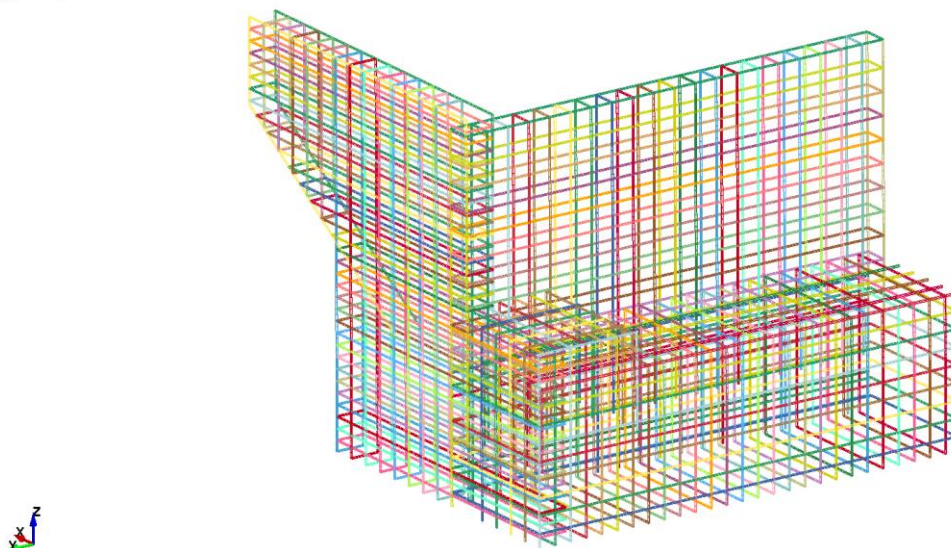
Vista de Acero en Modelo Estribo Completo de Puente Águila Norte.
